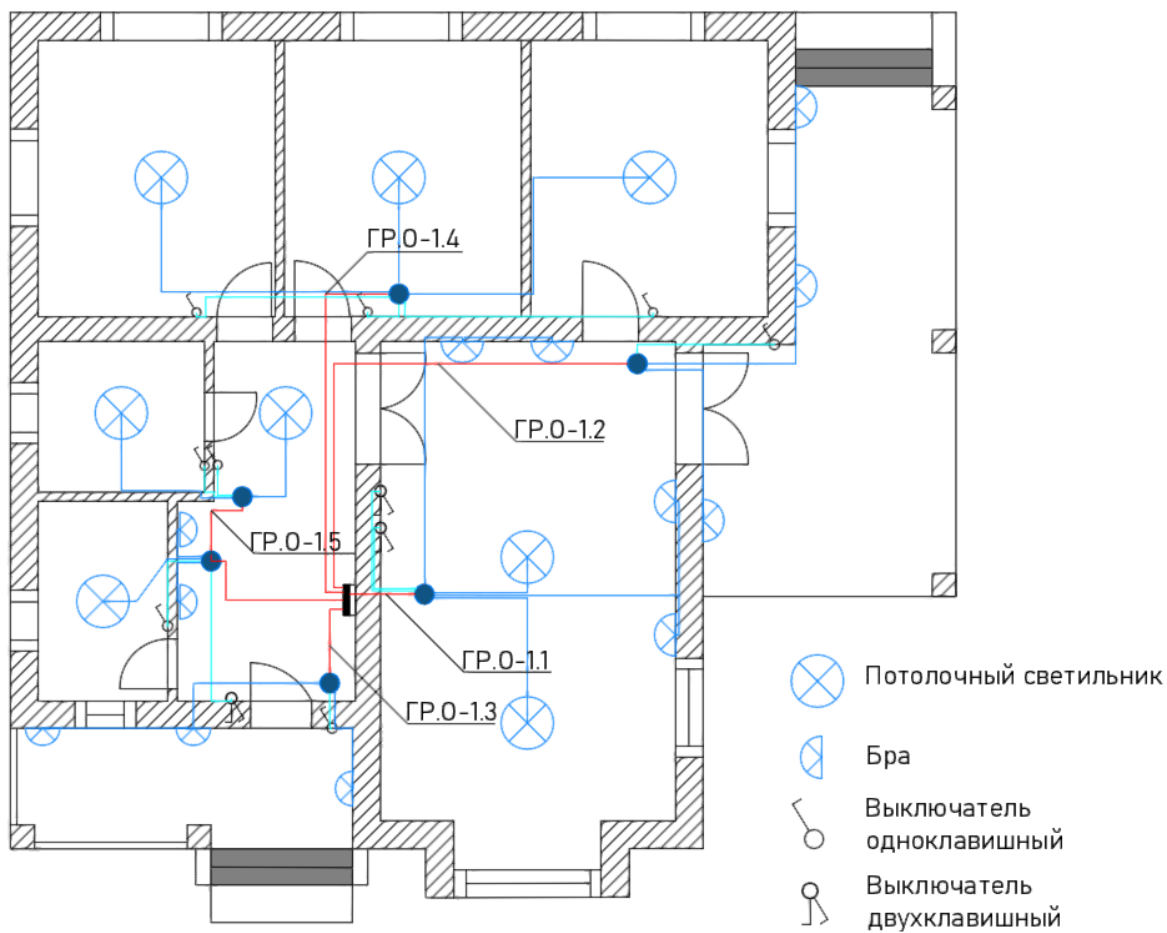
Схема расположения осветительной нагрузки в помещениях коттеджа
